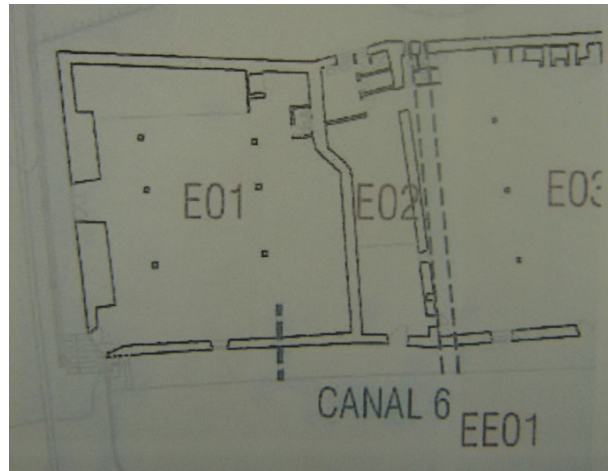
Localização em planta do Canal 6 (CCG Arquitectos Lda.).
